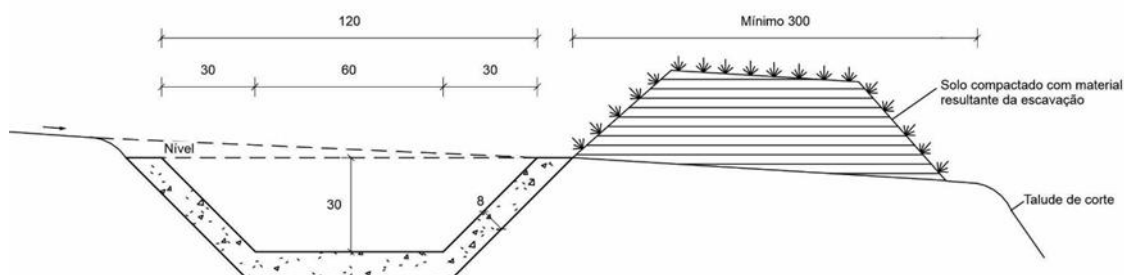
Valeta de Proteção de Corte em Concreto - VPCC 160-30.
